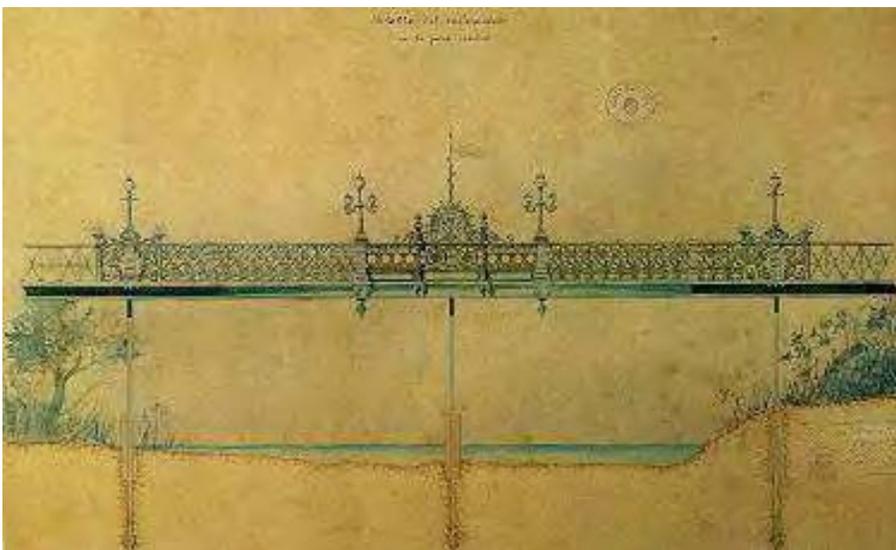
Puente de Abril, que colapsó en vísperas de su inauguración.
